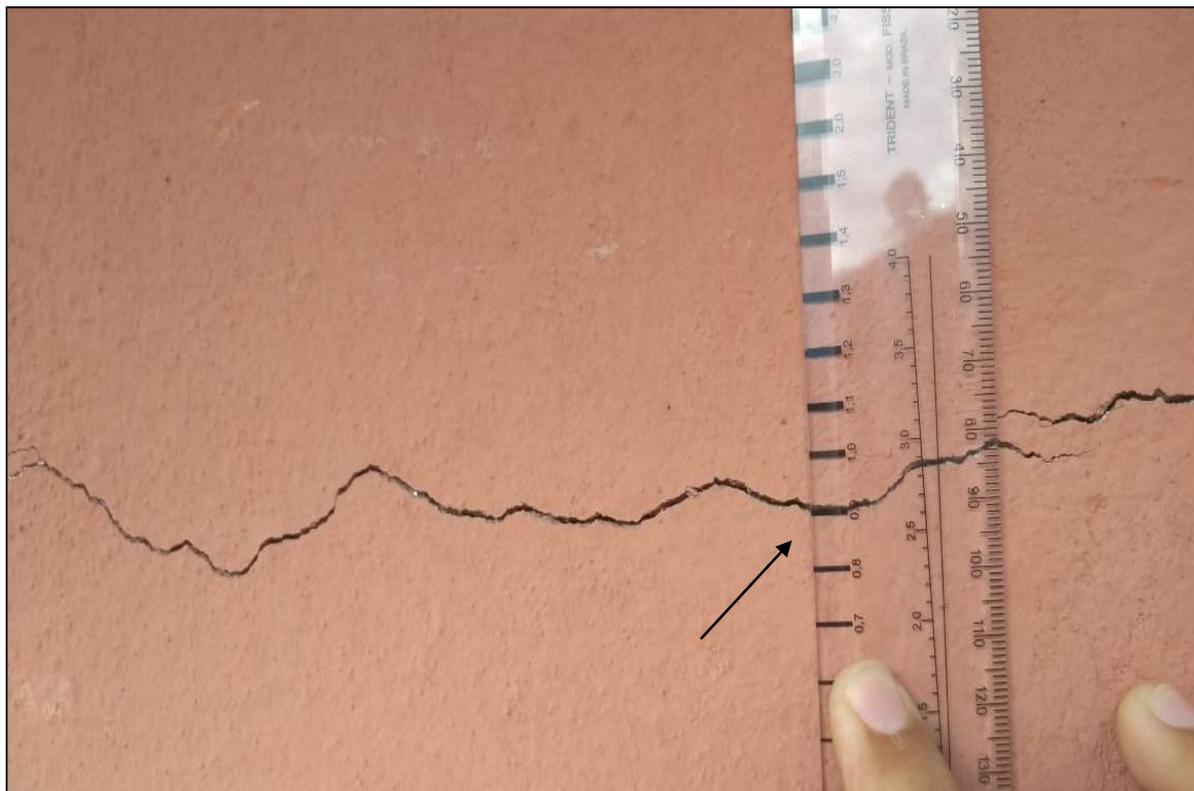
Medição com fissuometro, fissura de 0,5 mm
